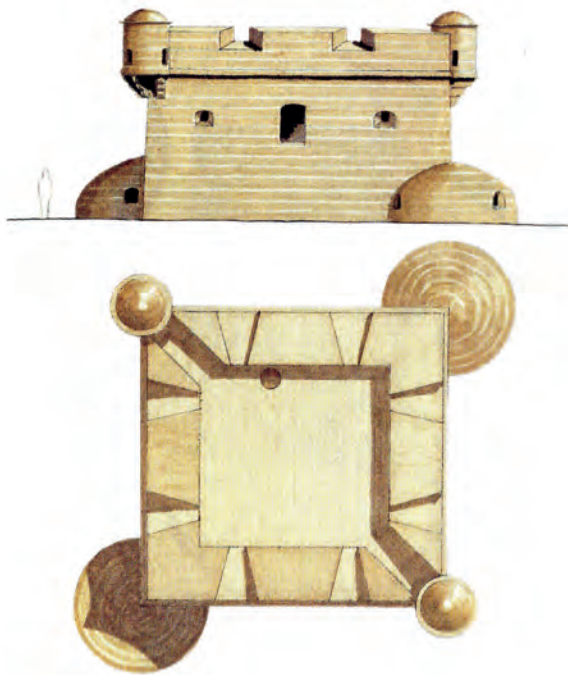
Planta y alzado de la reconstrucción propuesta por A. Banyuls, J.V. Boira y J.A. Lluesma (1996).
